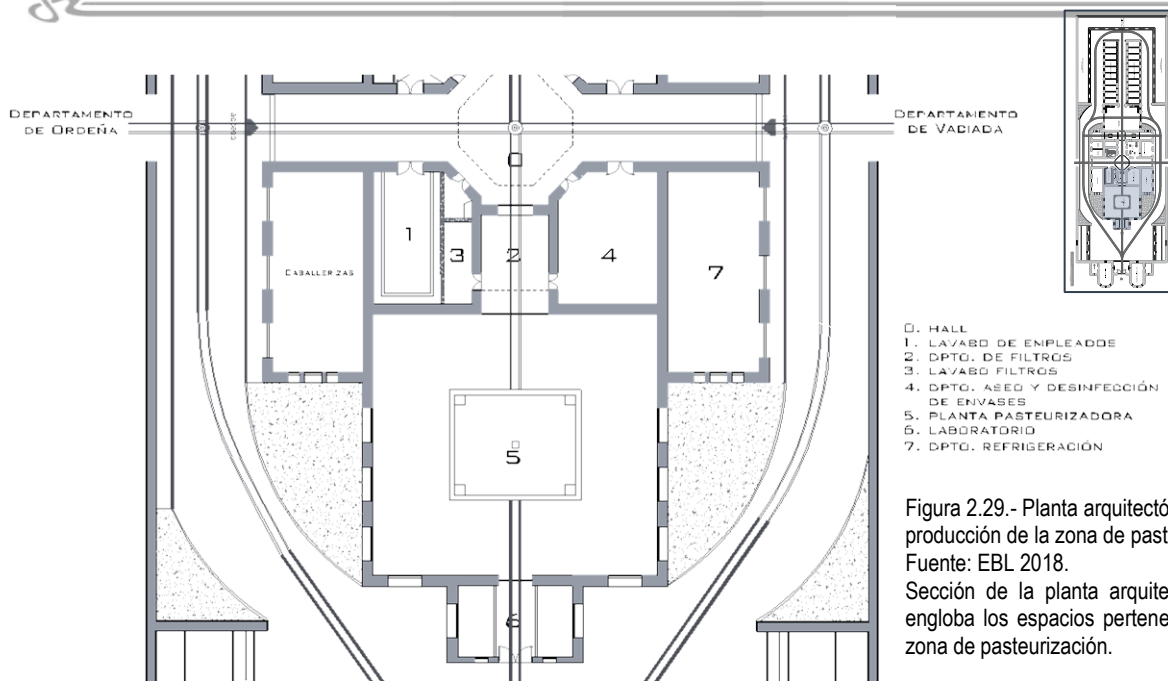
Planta arquitectónica de la producción de la zona de pasteurización. Fuente: EBL 2018. Sección de la planta arquitectónica que engloba los espacios pertenecientes a la zona de pasteurización.
